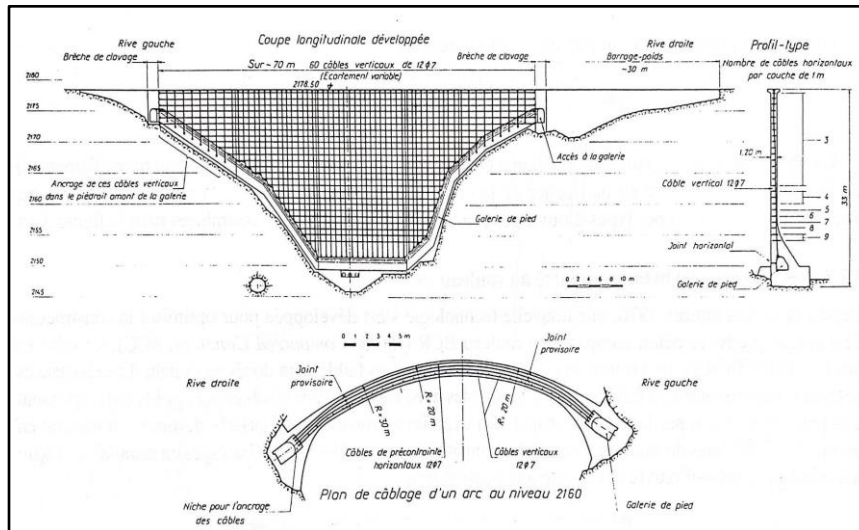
Barrage de Tourtemagne: câblage dans une coupe longitudinale développée et en coupe horizontale. [2]
